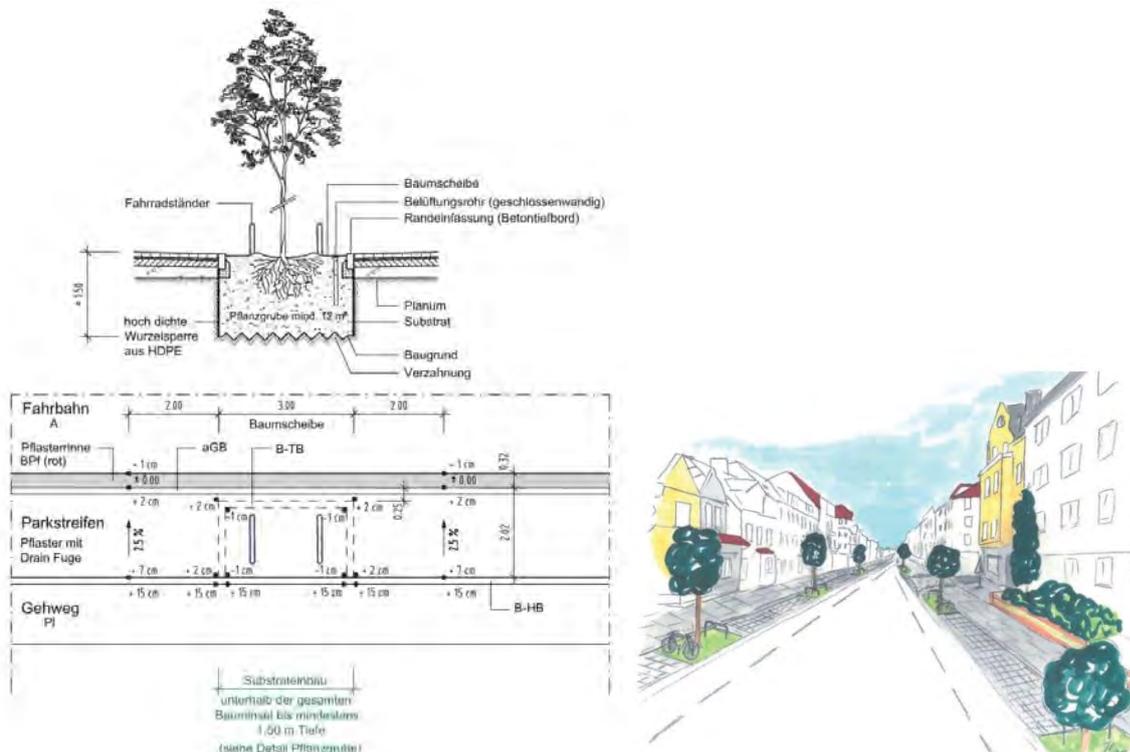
Detailplanung der Baumscheibe an der Münchener Straße in Bremen (Quelle: Stadt Bremen 2014).
